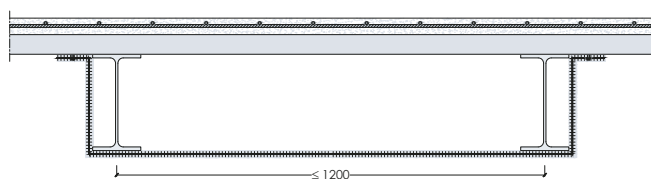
Schema di applicazione per protezione di più travi in carpenteria metallica (applicazione a box)
